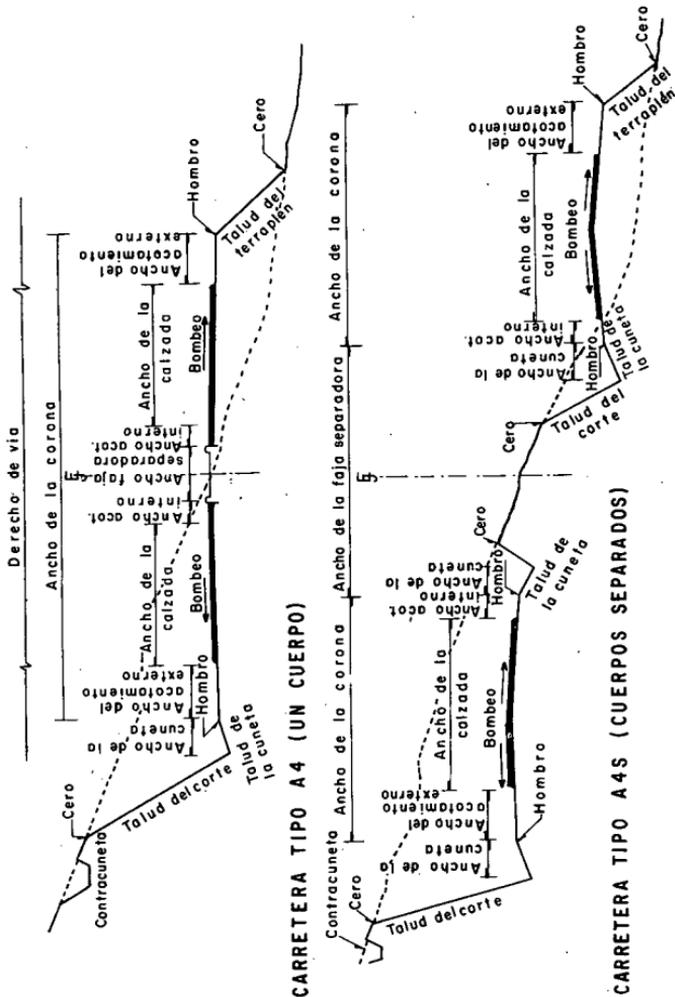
SECCION TRANSVERSAL EN TANGENTE DEL ALINEAMIENTO HORIZONTAL PARA CARRETERA TIPOS A4
